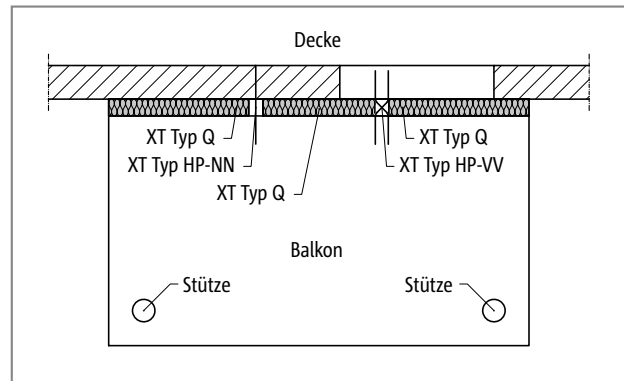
Schöck Isokorb® XT Typ HP: Balkon mit Stützenlagerung
